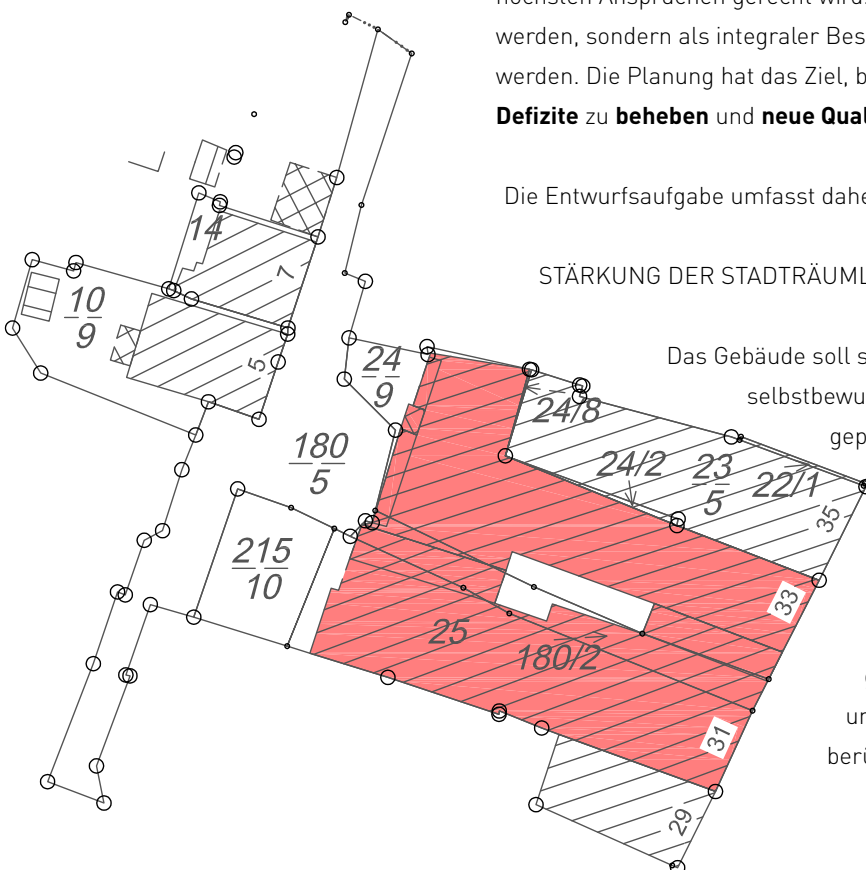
Lageplan Lange Straße 31/33 o.M.
